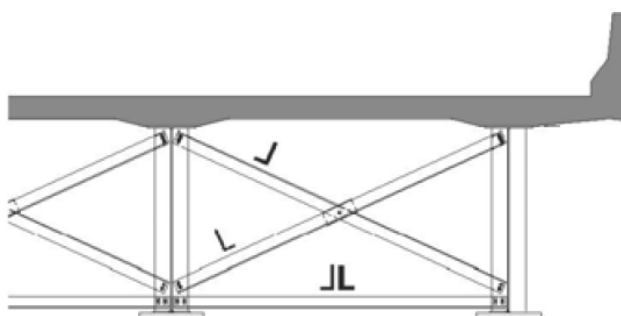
Arranjo das transversinas da ponte em vigas mistas (adaptado de BELLEI e PINHO, 2007)
